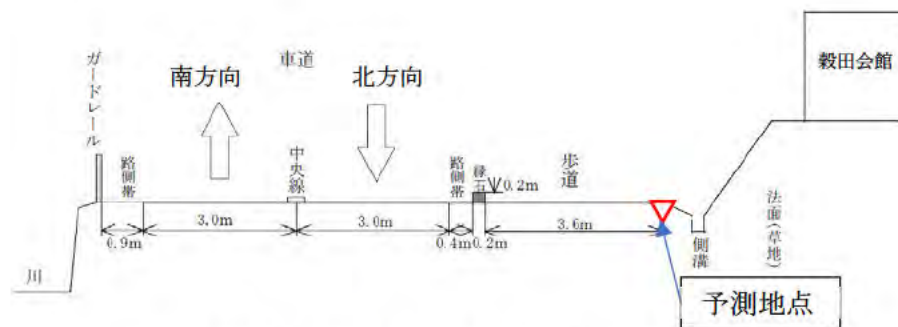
騒音予測地点e近傍の道路断面図
